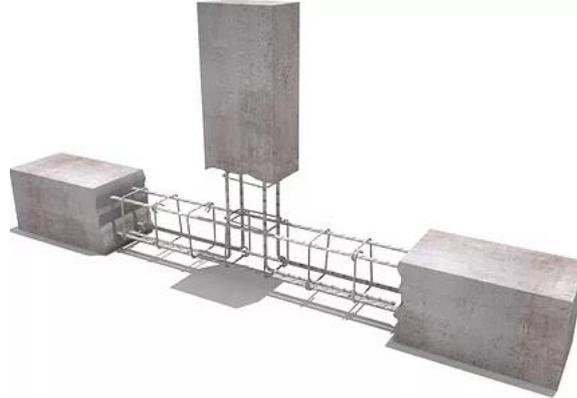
Demonstração virtual de estrutura em Concreto Armado – Fonte: Grupo Aço Danti, 2017
